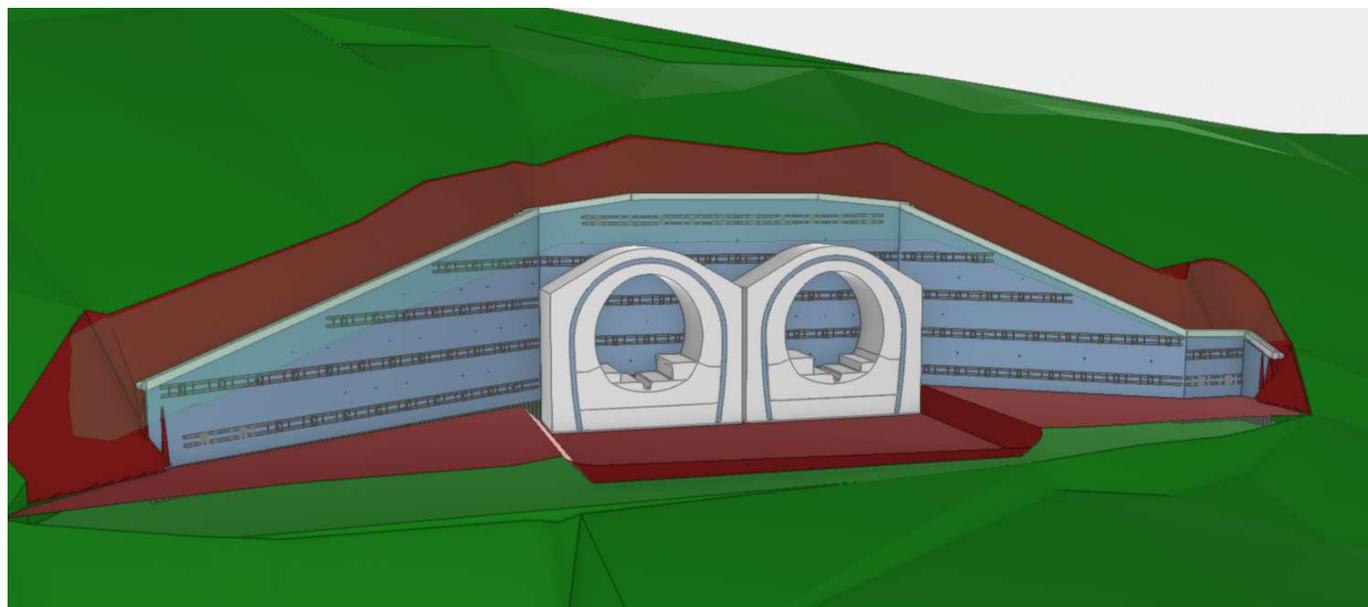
Vista prospettica dell'imbocco lato Bari
